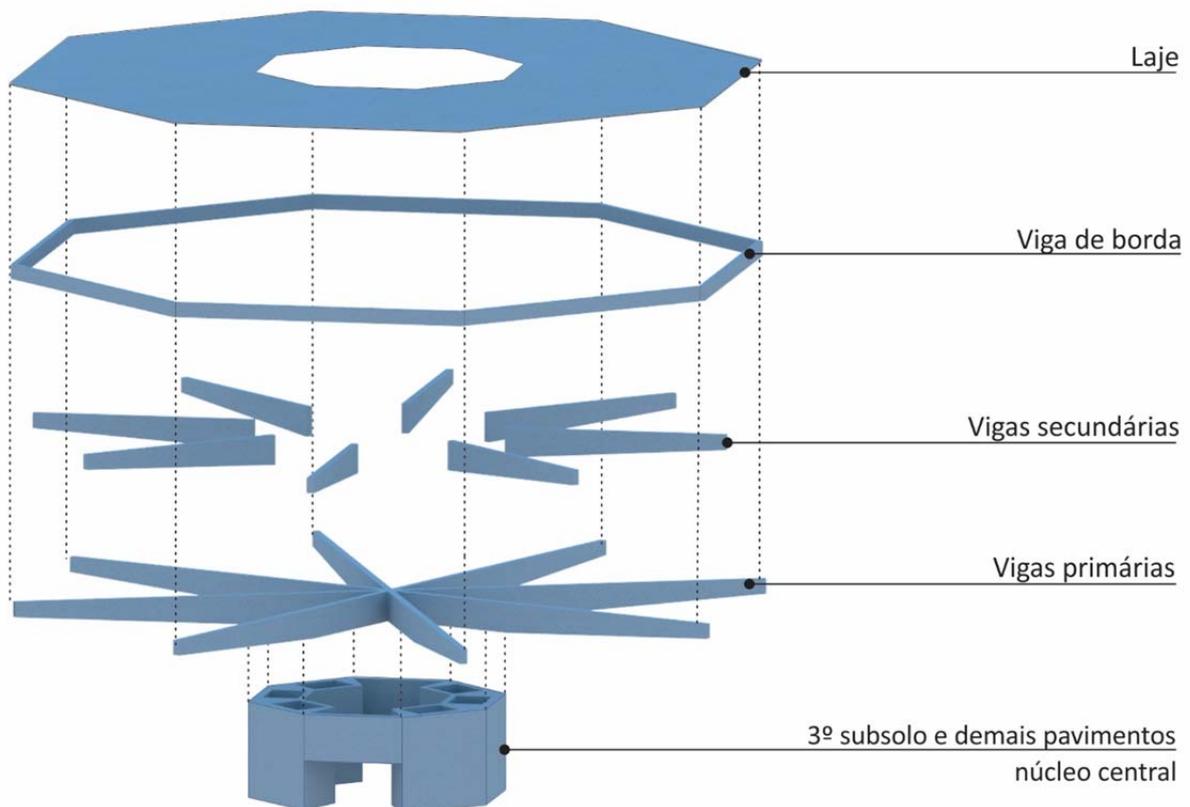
Esquema estrutural de apoio das lajes da torre da sede Banco Safra – 2ª opção
